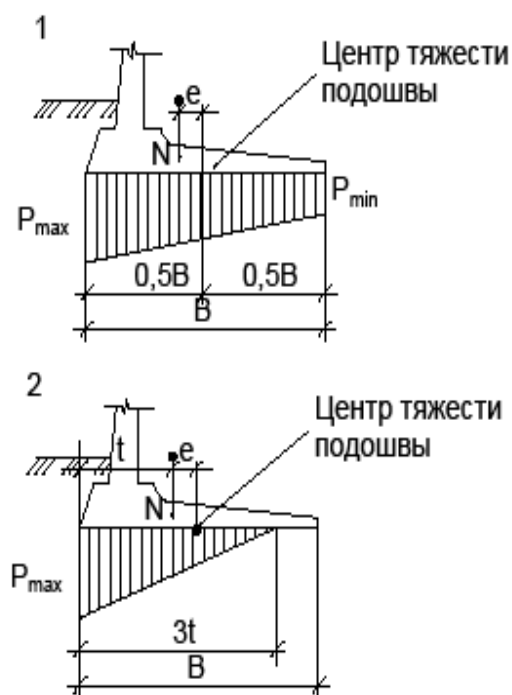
Схема к определению давления под подошвой фундаментной плиты
